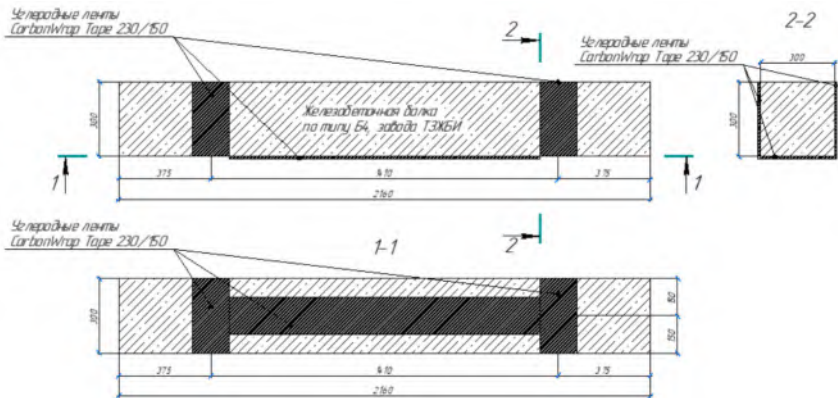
Рекомендуемая принципиальная схема внешнего усиления железобетонных балок с применением углеродных лент CarbonWrap Tape 230/150
